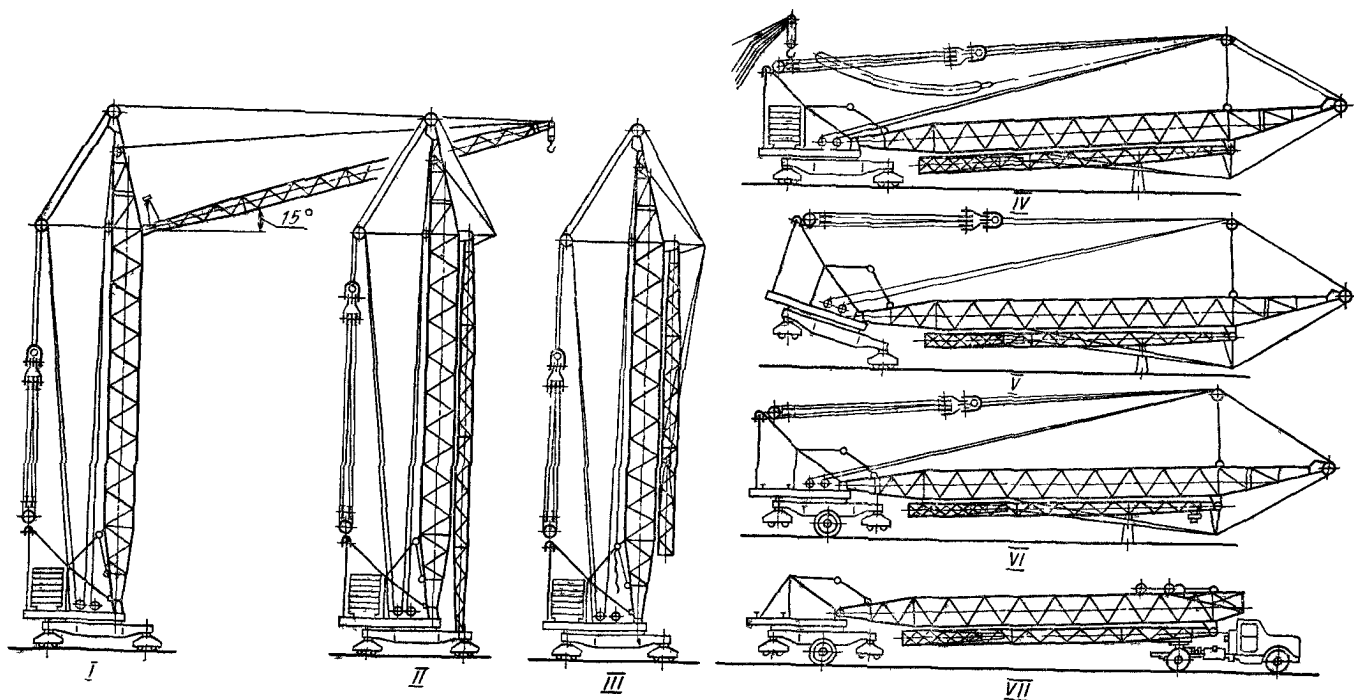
Схема монтажа и демонтажа крана с поворотной башней
